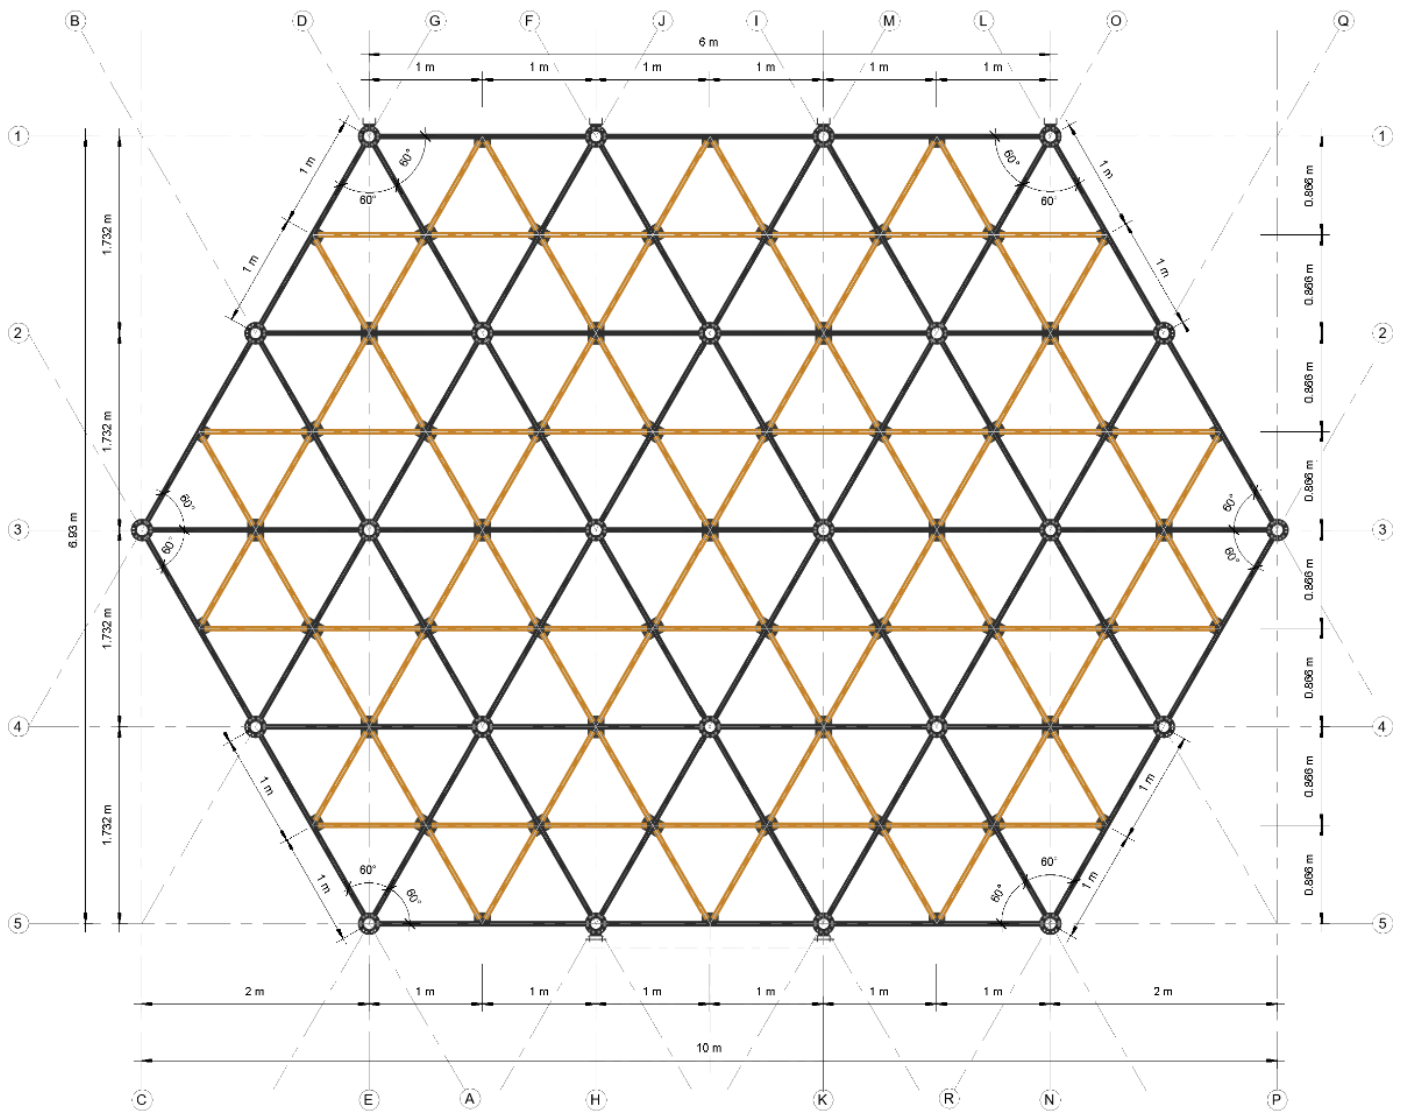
Planta de estructura de piso.<sup>240</sup>
